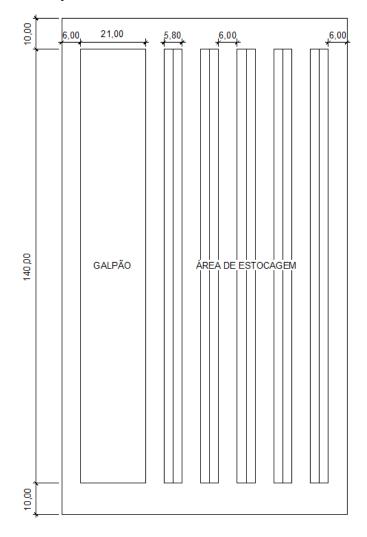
Layout e área total da fábrica de dormentes de concreto
